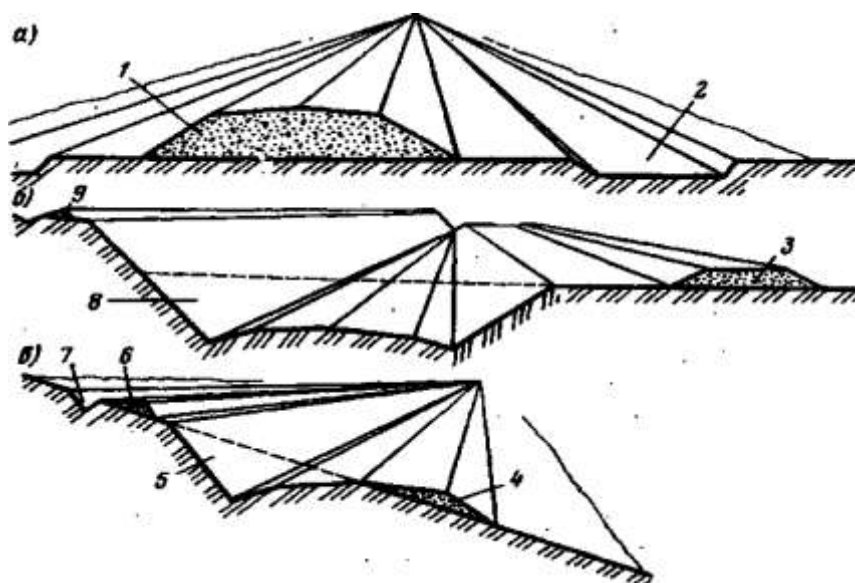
Поперечные профили грунтовых дорог:
